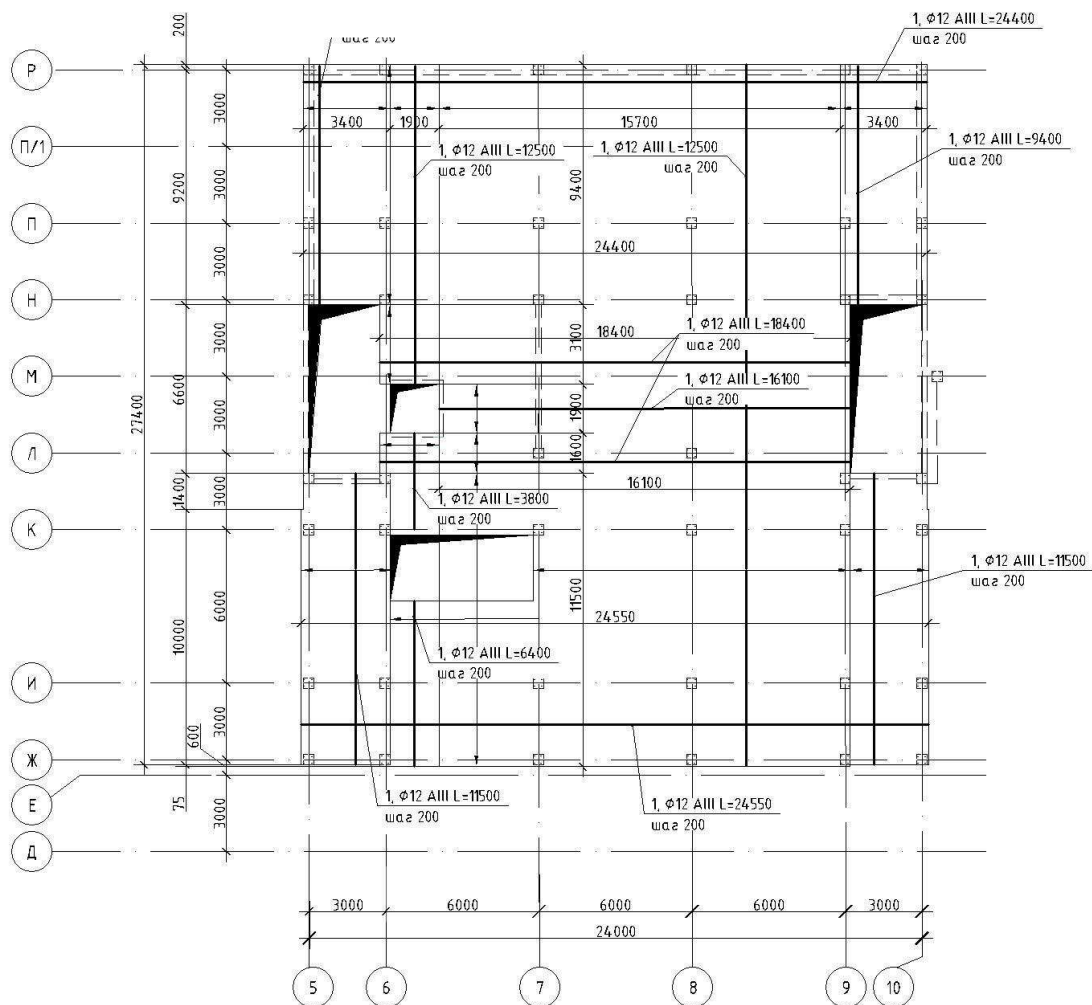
Плита перекрытия на отм. 0,000 в осях Ж-Р/5-10
